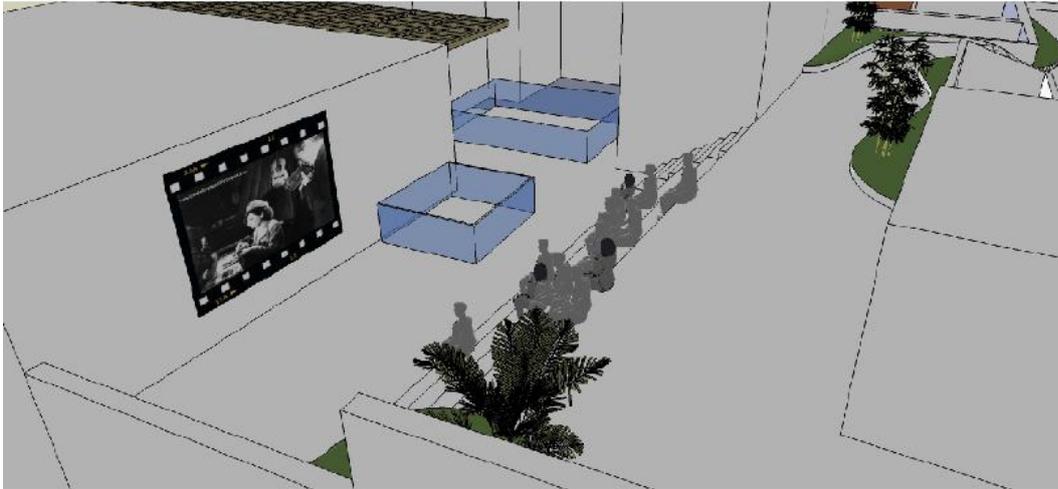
Imagen 3D de la zona de cine al aire libre, vinculada a la cafetería-restaurante y al centro cultural, prevista en la cubierta de la manzana 303.
